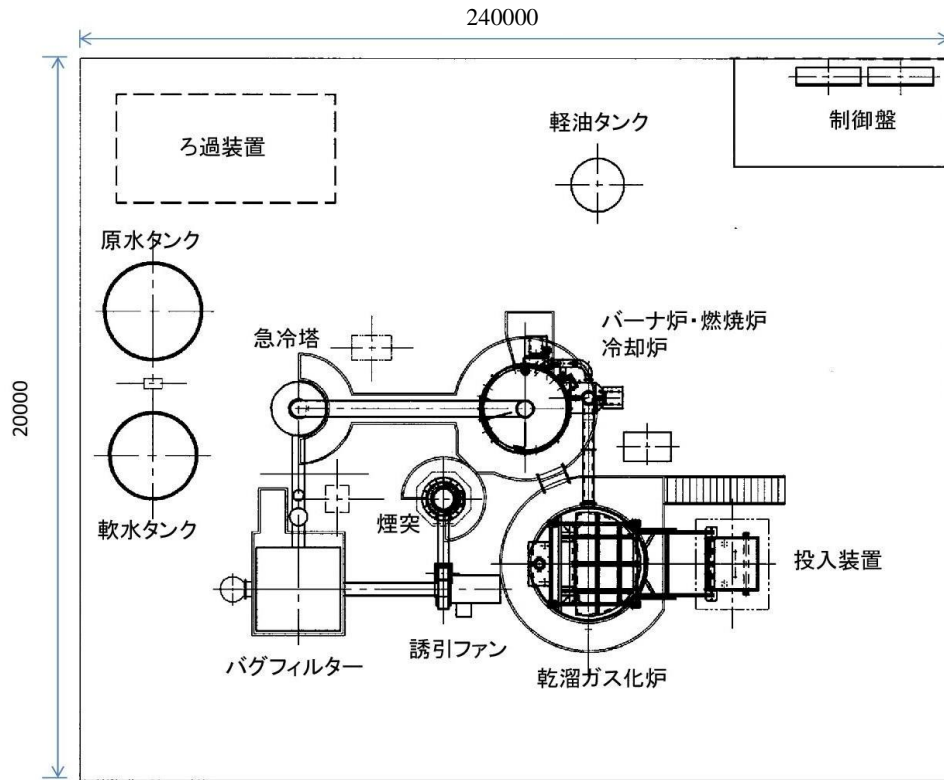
乾溜ガス化焼却装置 平面図 (出典：㈱キンセイ産業)
